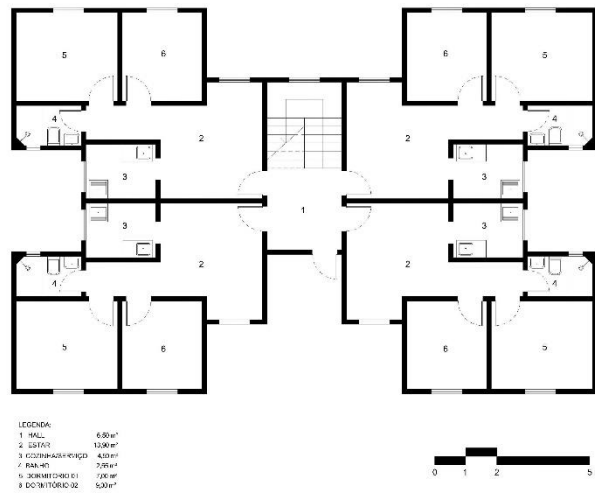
Planta baixa do Conjunto Habitacional Jardim Boqueirão I e II - Passo Fundo
